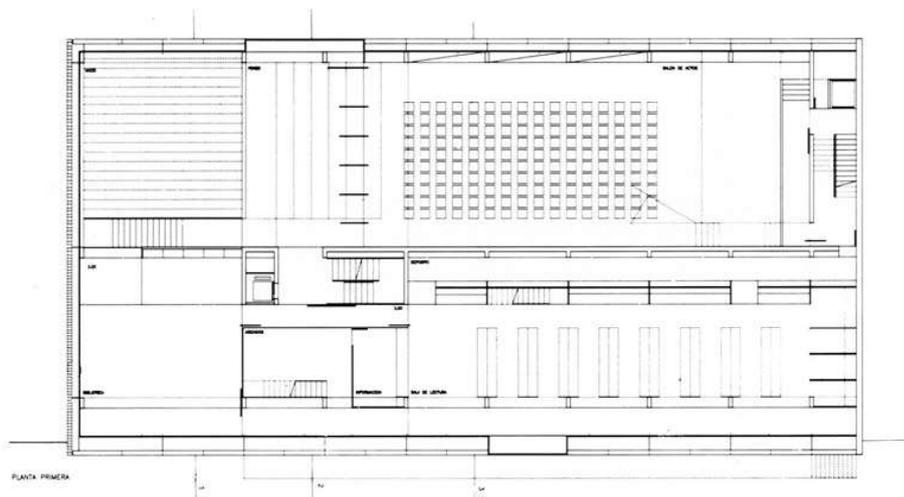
Plano planta concurso Centro Cultural “Las fronteras” en 1994
